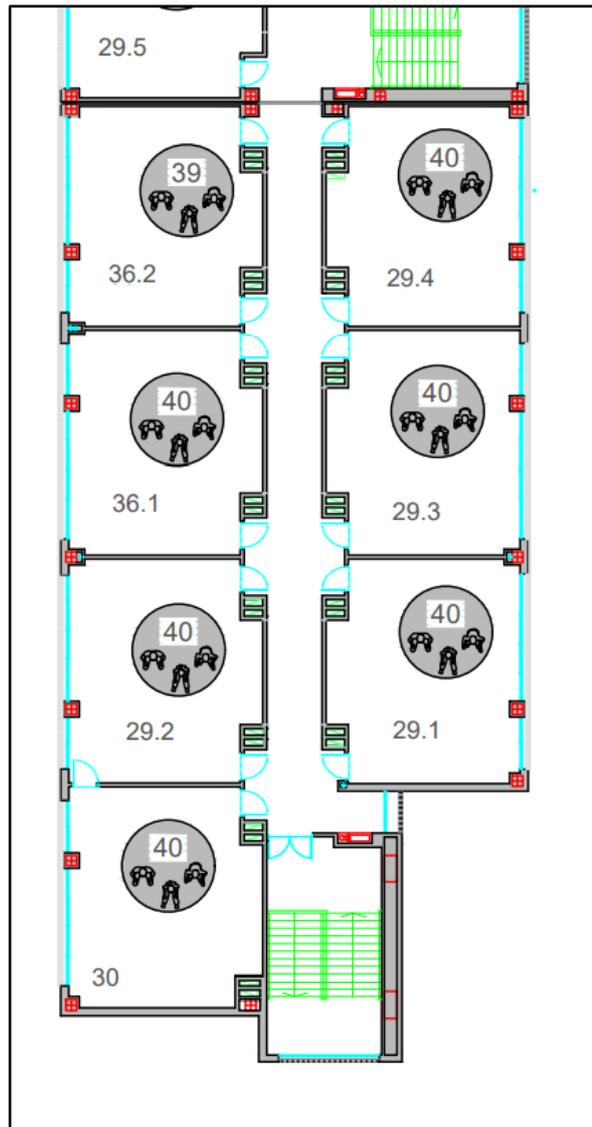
Plano con ocupación por aula de la planta dos – mitad inferior
